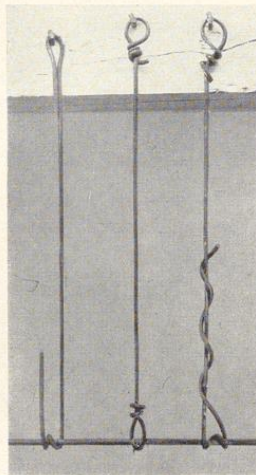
Richtig geschlossene Abhänger und richtiger Hakeneinschlag
